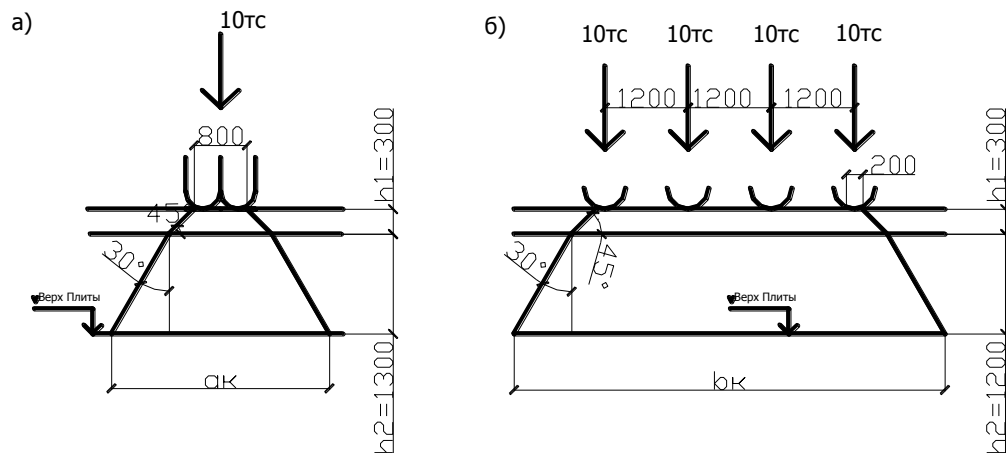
Размеры площади давления от колесной нагрузки а) поперек движения б) вдоль движения
